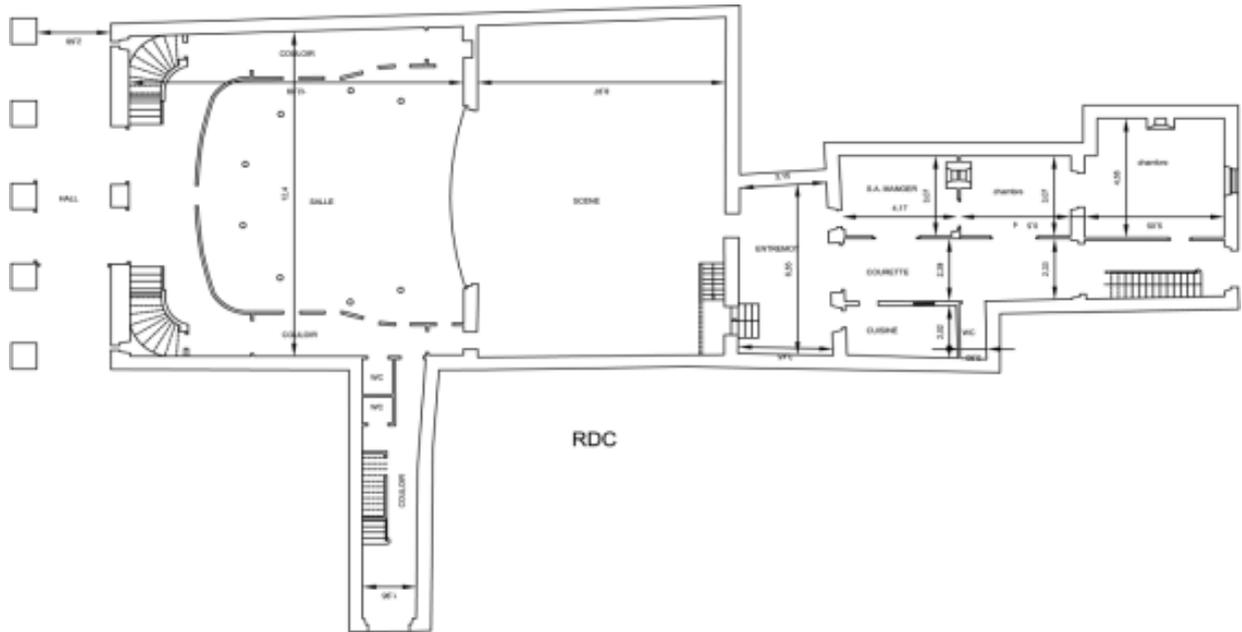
plan de rez de chaussé du théâtre municipal de Blida 1852/1853, (les archives de la mairie).
